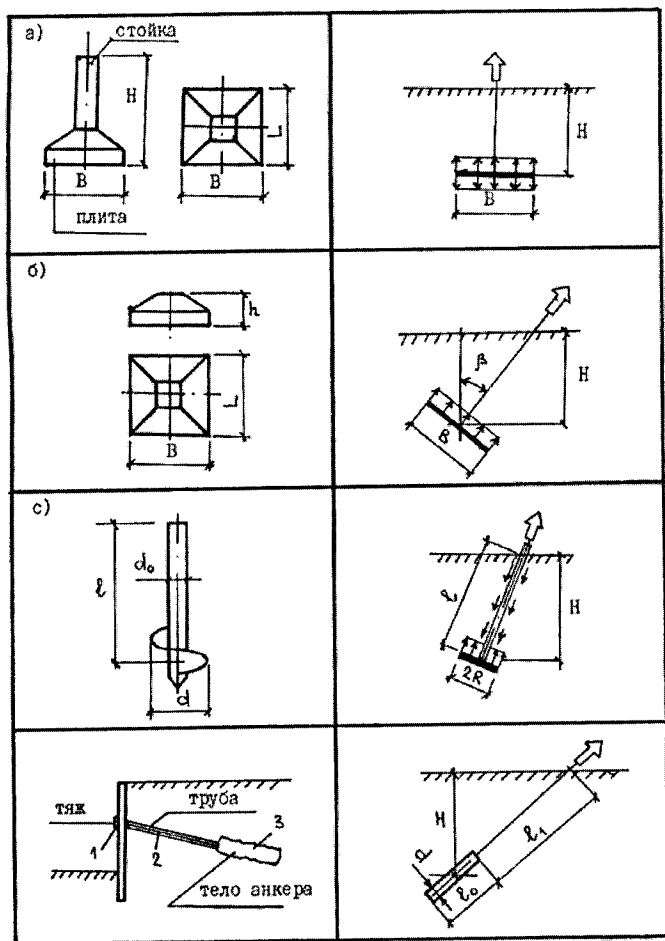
Конструкція і розрахункові схеми анкерних фундаментів:
